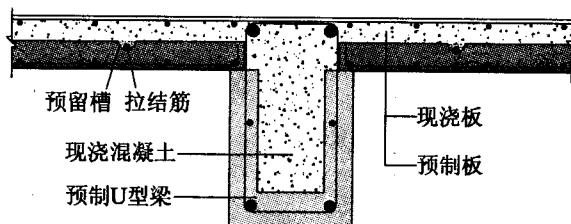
钢筋混凝土 U 型叠合梁截面
